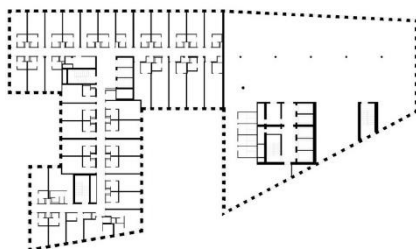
Планировочное решение первого этажа «Grosspeter Tower»
